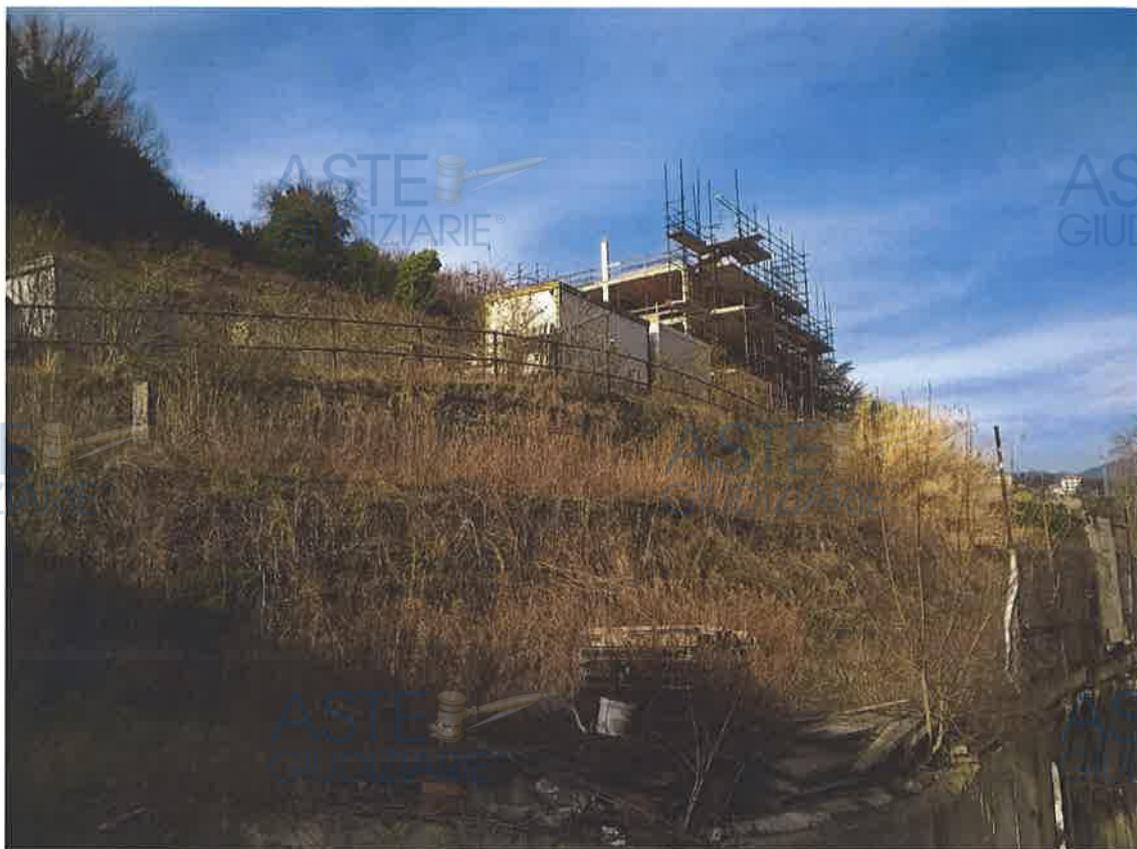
terre armate interne al tornante rampa di accesso all'edificio
